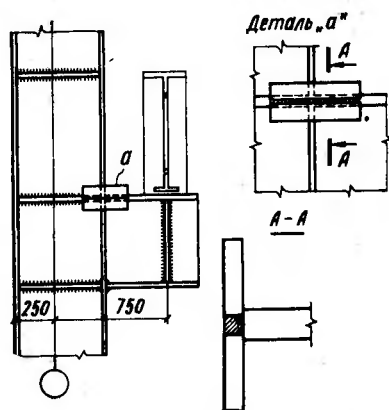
Узел опирания подкрановой балки на колонну постоянного сечения (из одного двутавра)
